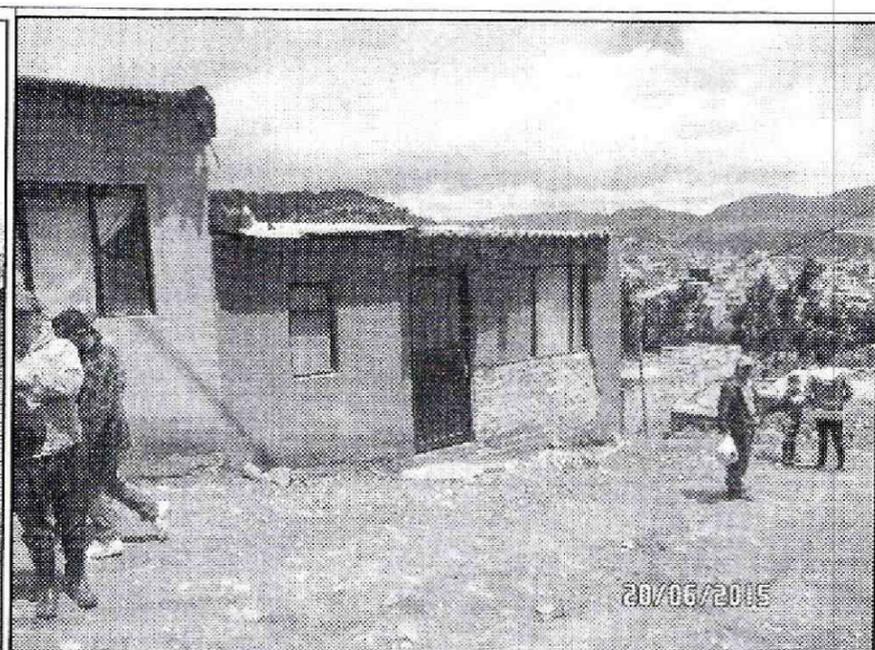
Vista de la grieta de tracción localizada en la parte alta de la ladera.
